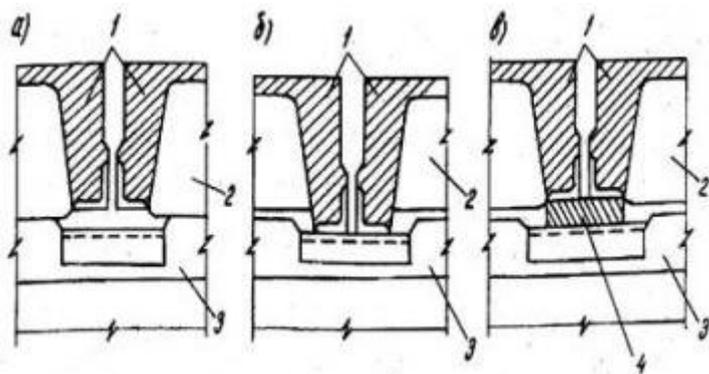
Схема дефекта узла опирания плит перекрытий на ригели и его исправления в каркасных зданиях серии ИИ-20/70 и 1.420-12:
